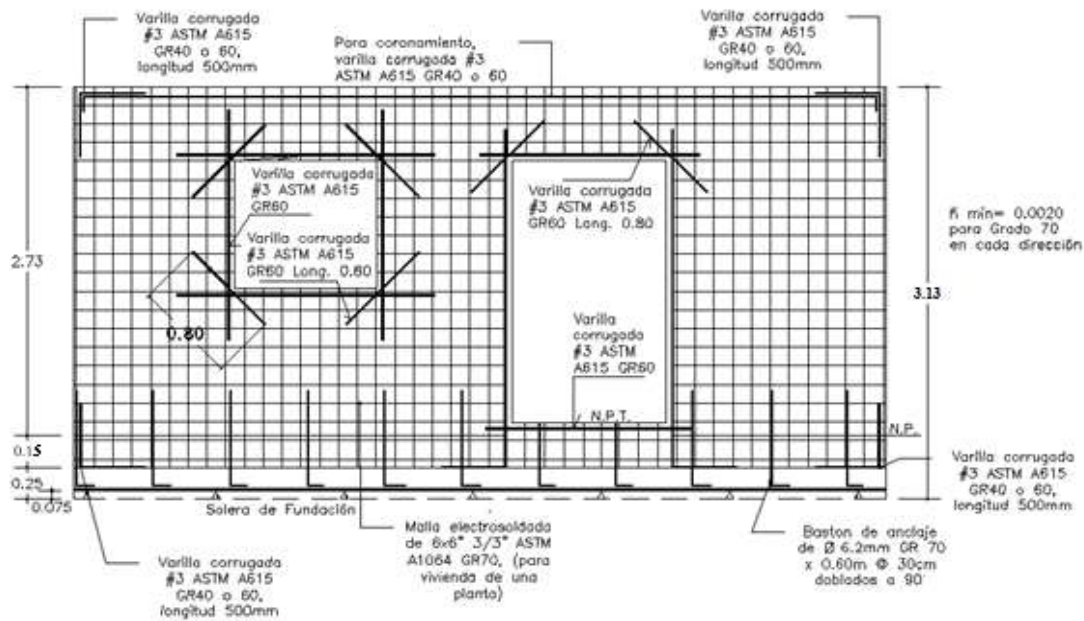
a Detalle típico de refuerzo en pared de concreto reforzado, para vivienda de una planta, con acero grado 70
